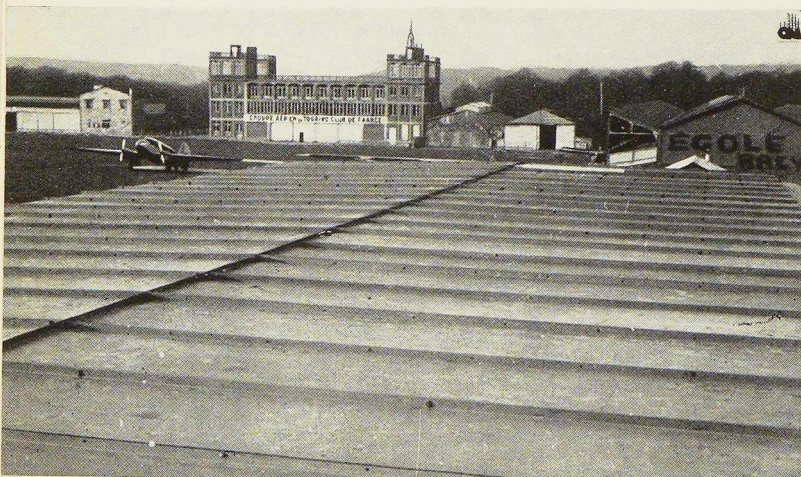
Vue d'ensemble de la toiture en tôle, avant la pose des couvre-joints.
